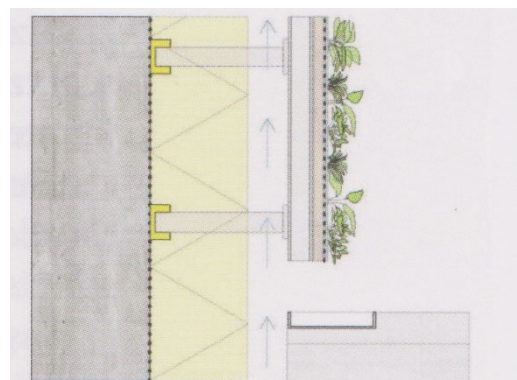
Konstruktion von flächiger Bauweise bei gedämmtem Aufbau
